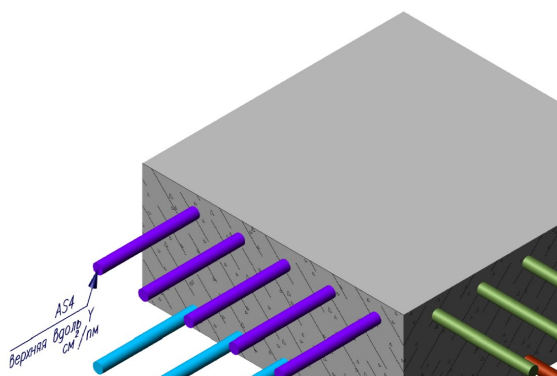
Схема армирования горизонтальных пластинчатых элементов (перекрытий).
